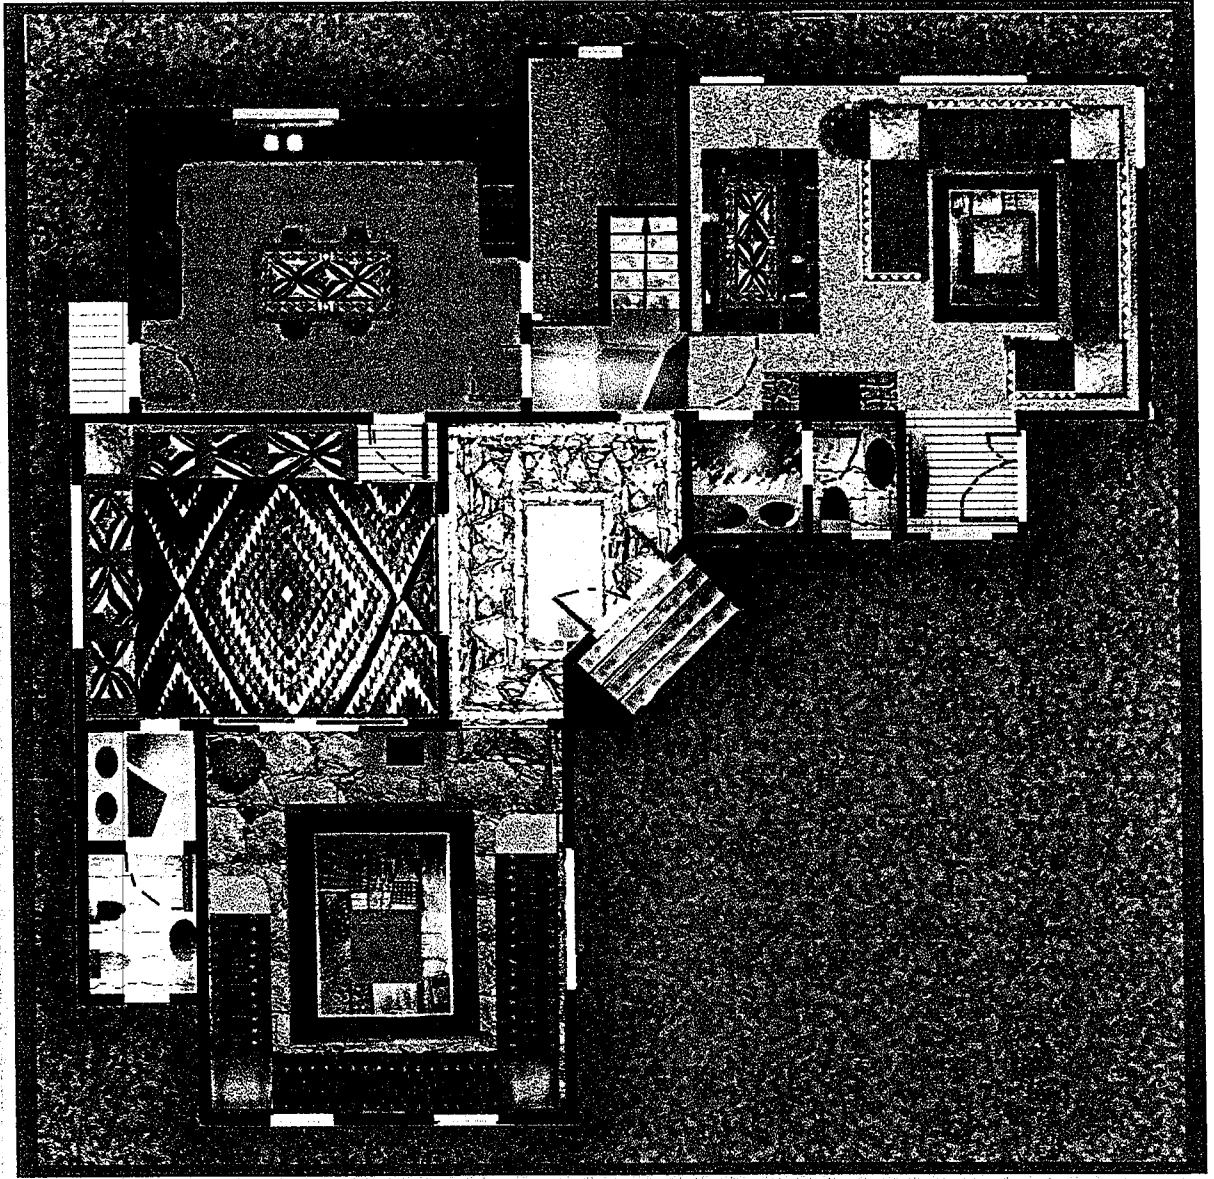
مسقط أفقي للدور الأرضي (نموذج ١)
